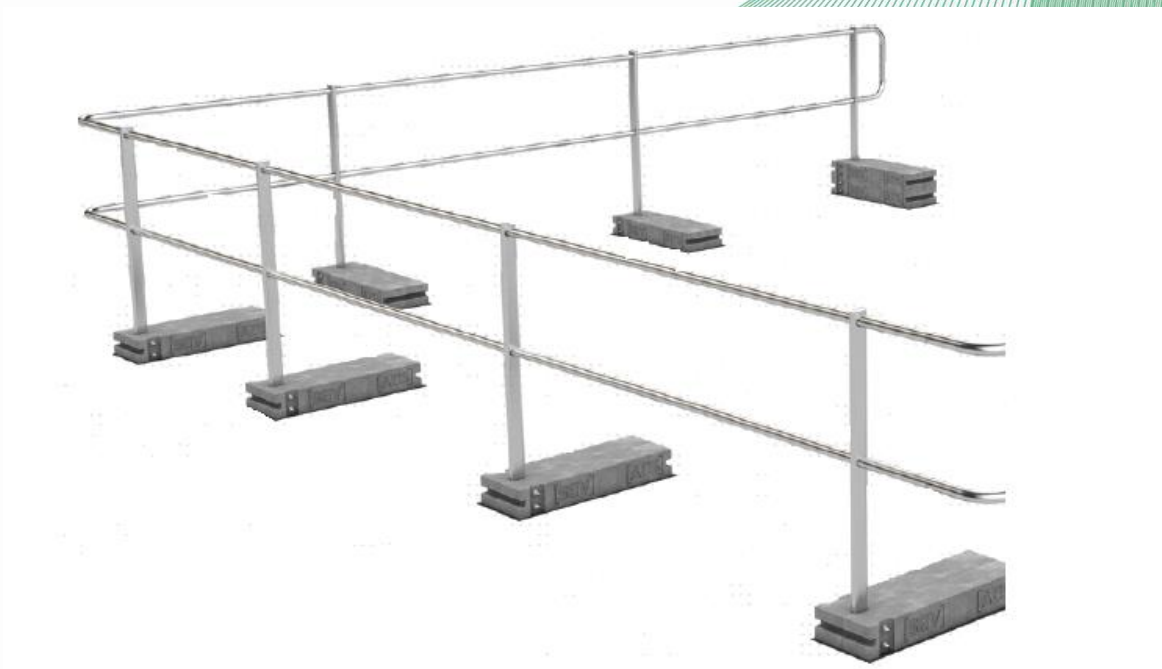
Garde-corps, type : ABS Guard onTop Weight (exemple de montage avec poids en béton)
